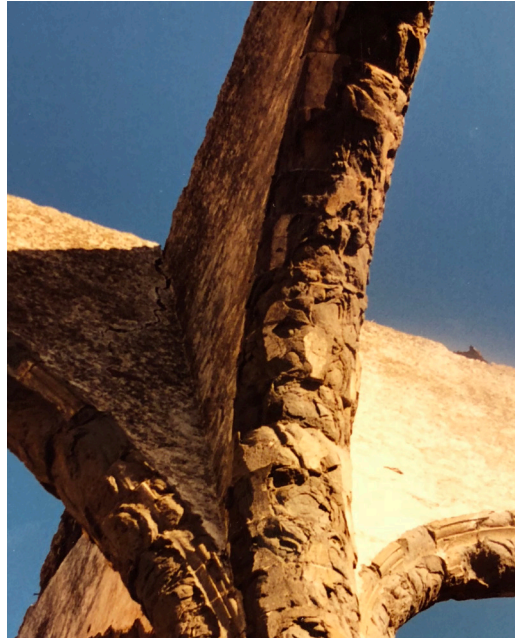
Detalle fragmentación del basalto y grietas en la coronación (Autor: Amparo Martín, 1996)
